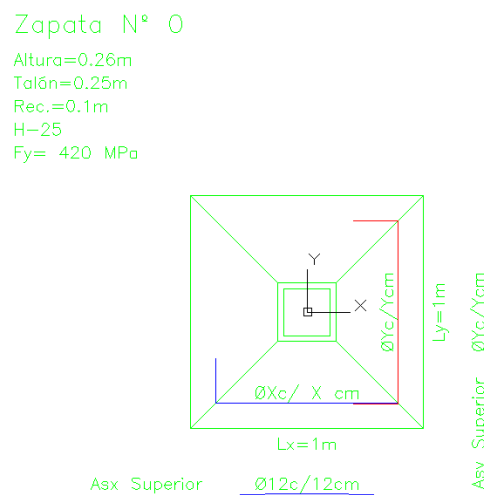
Ejemplo zapata con armadura superior, opción Plantas. Fuente: elaboración propia
